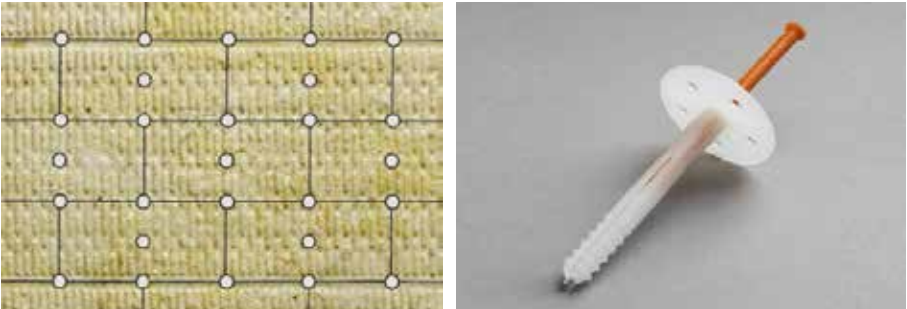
Detalles de la colocación y anclajes en un sistema SATE.
